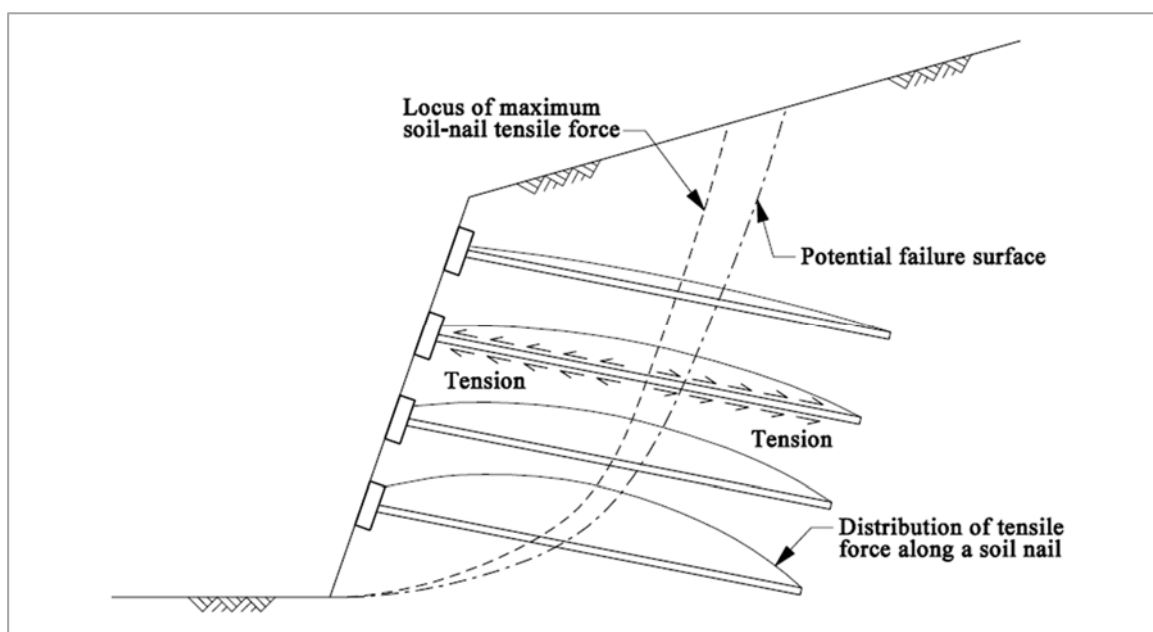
Distribuzione delle forze di trazione in una parete in Soil Nailing secondo la Geoguide 7 (Geotechnical Engineering Office, 2008).
